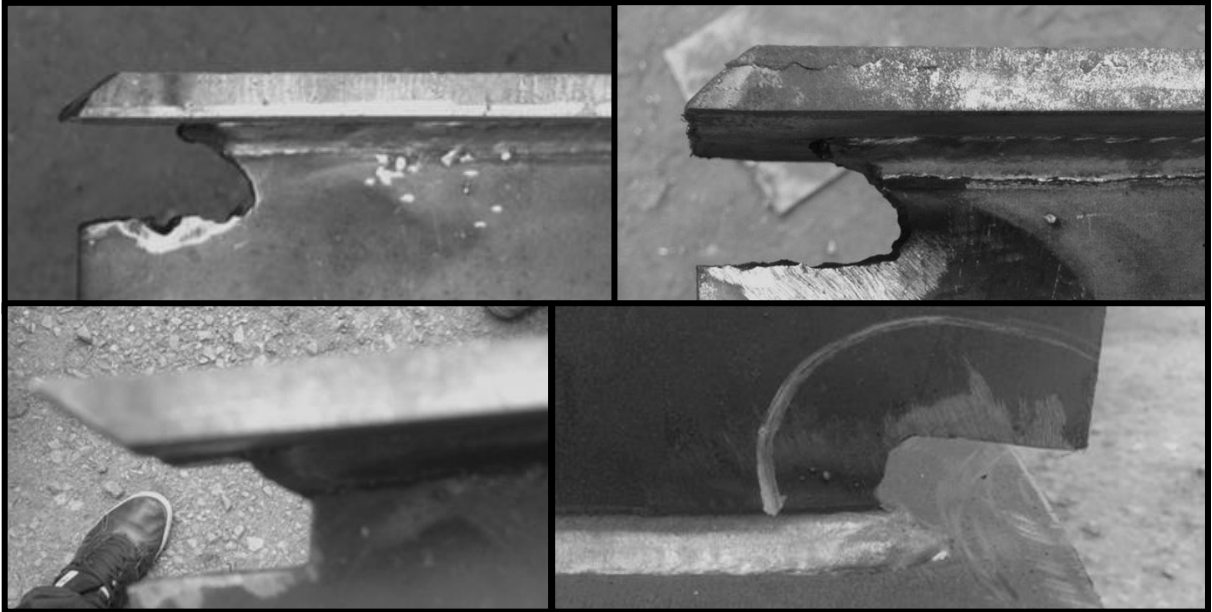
Agujero de acceso para soldadura ejecutado erróneamente.
